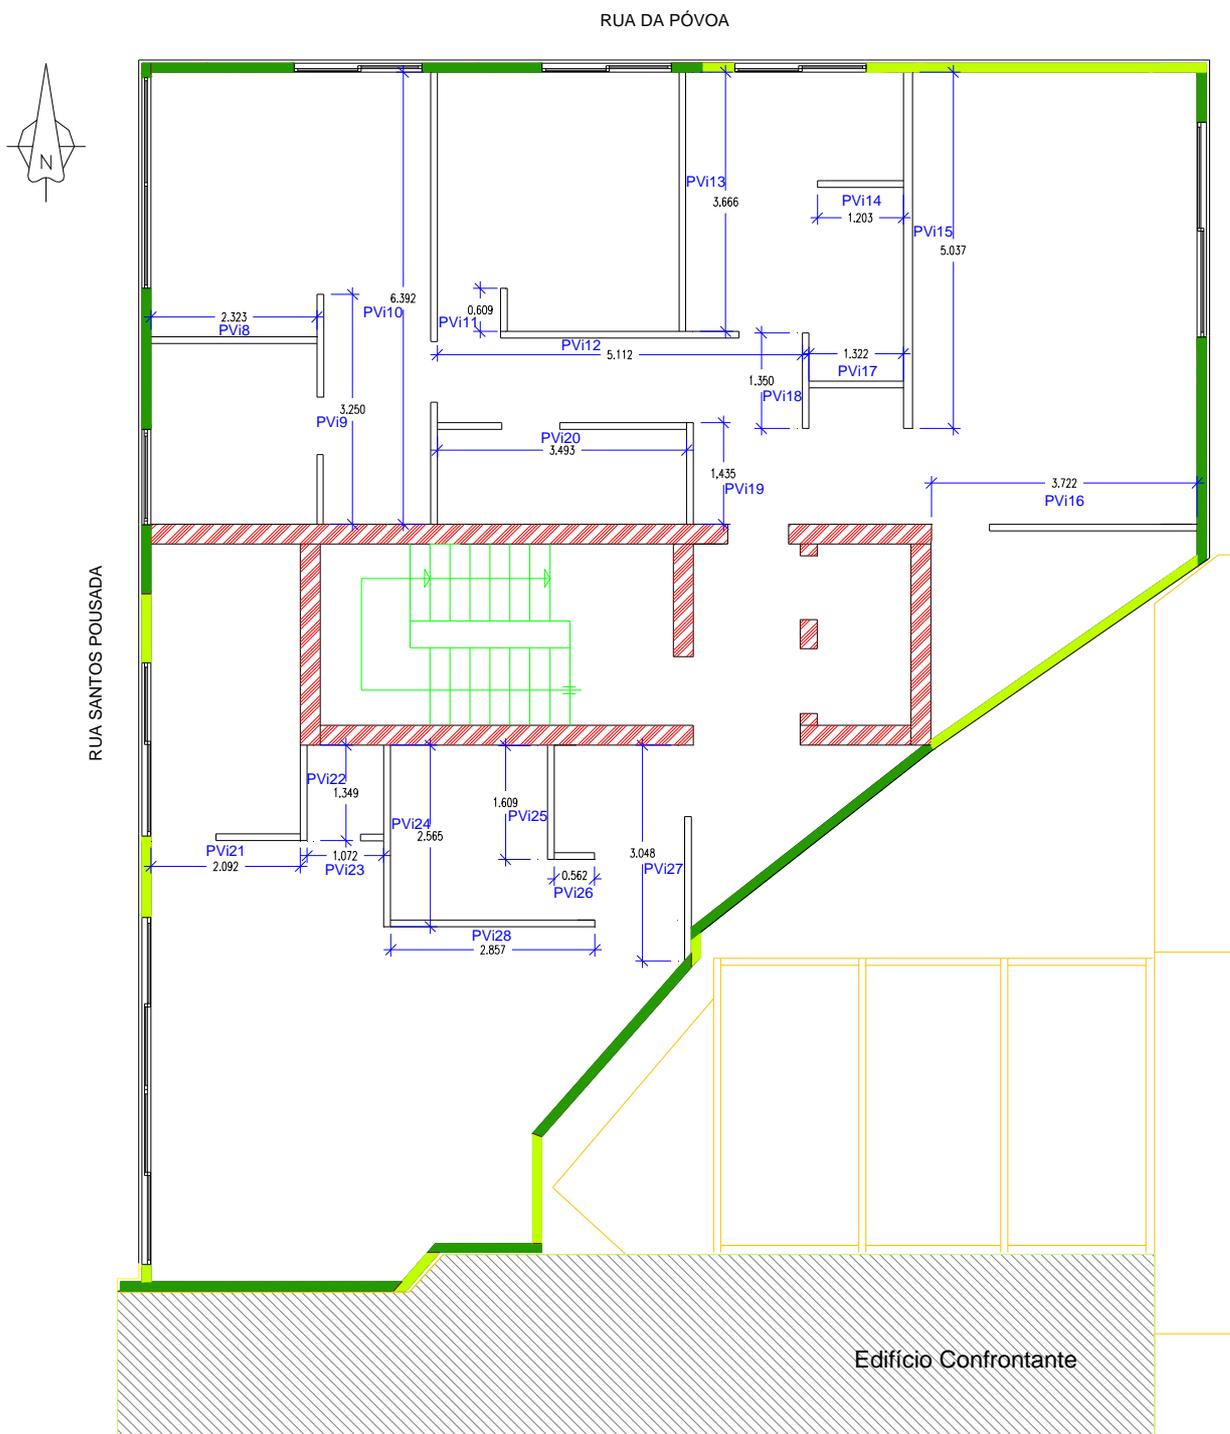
Planta de painéis verticais interiores – piso-tipo
